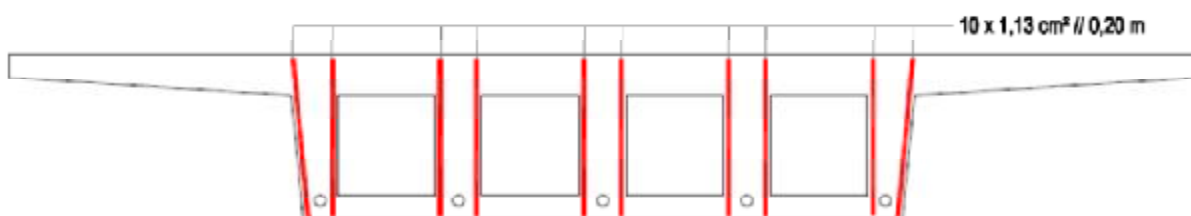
Esquematização das armaduras de esforço transversal do tabuleiro na zona vazada a meio-vão
